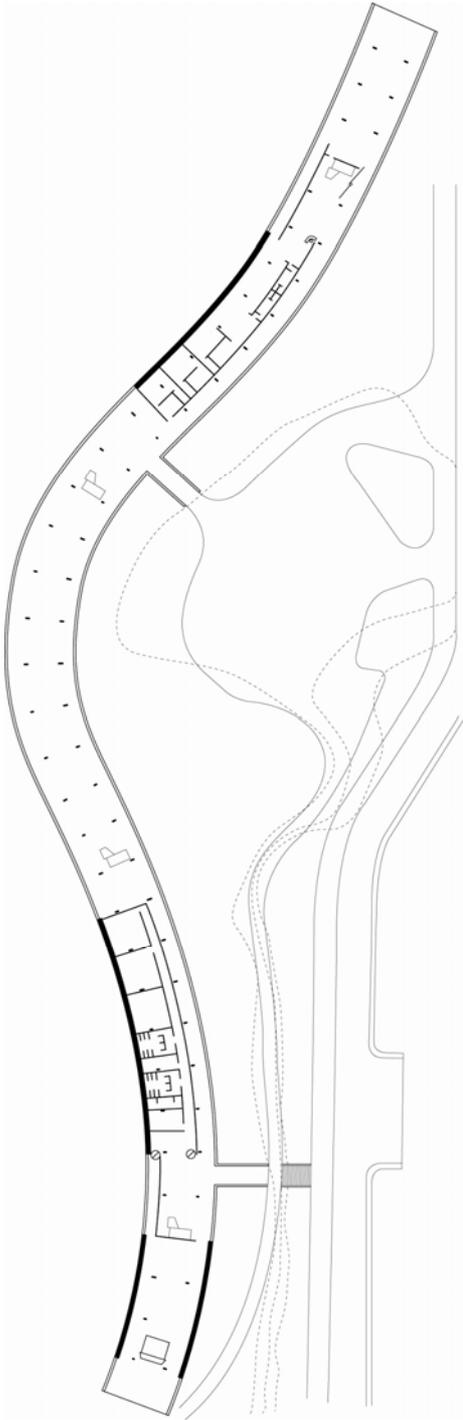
Planta pavimento intermediário, nível 3, Conjunto Pedregulho 1950-1952. (Fonte: FRENCH, 2009).
